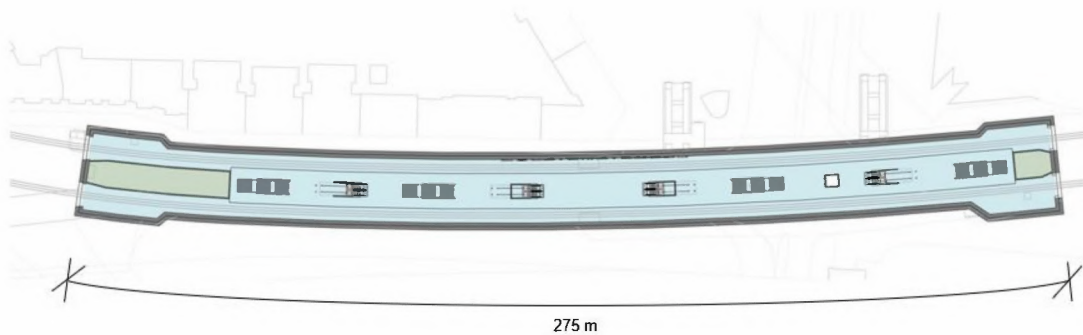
Hp Holstenstraße Var. I – Grundrisse
